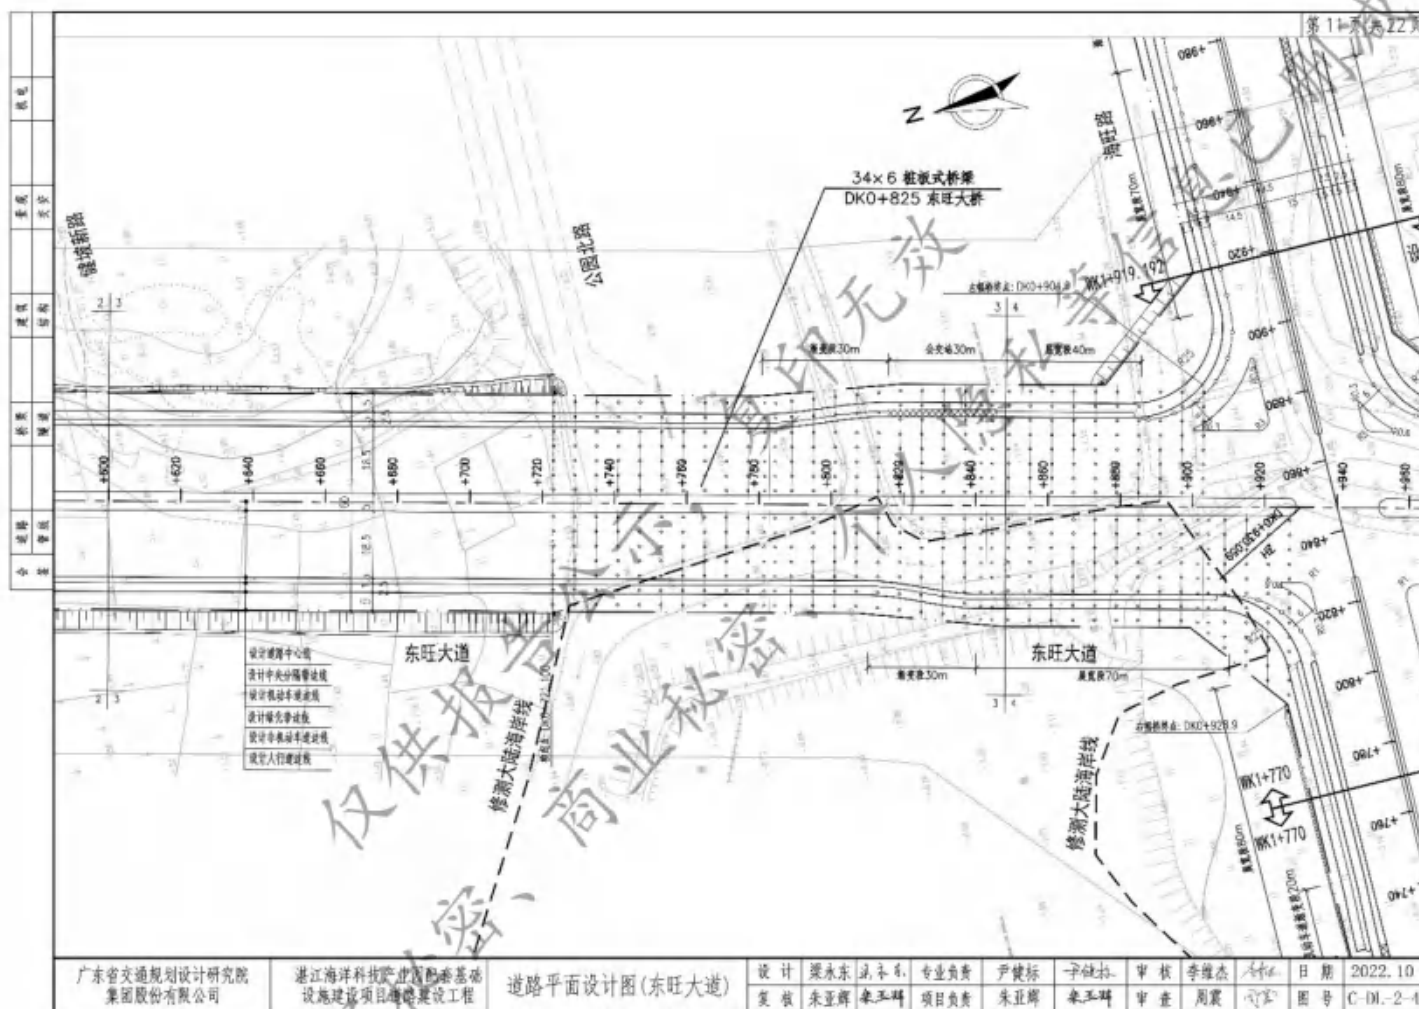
b 东旺大道桥梁总平面布置图 (2)
